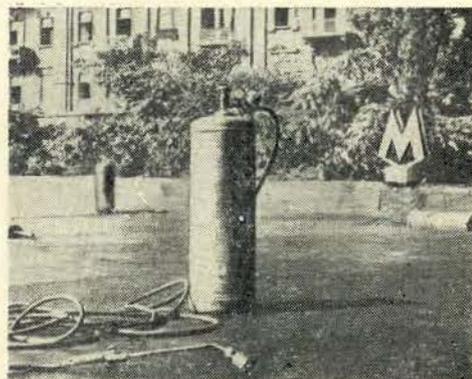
Комплект оборудования газопламенной установки: пропановый баллон, редуктор пропановый, нагревательная газозовоздушная горелка.
